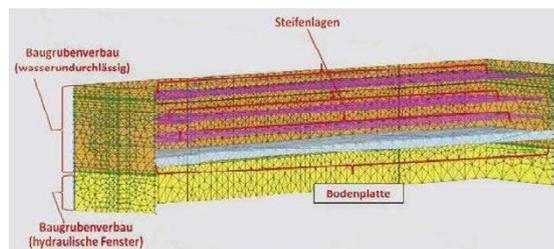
Station Güterplatz – Modellierung der konstruktiven Elemente
